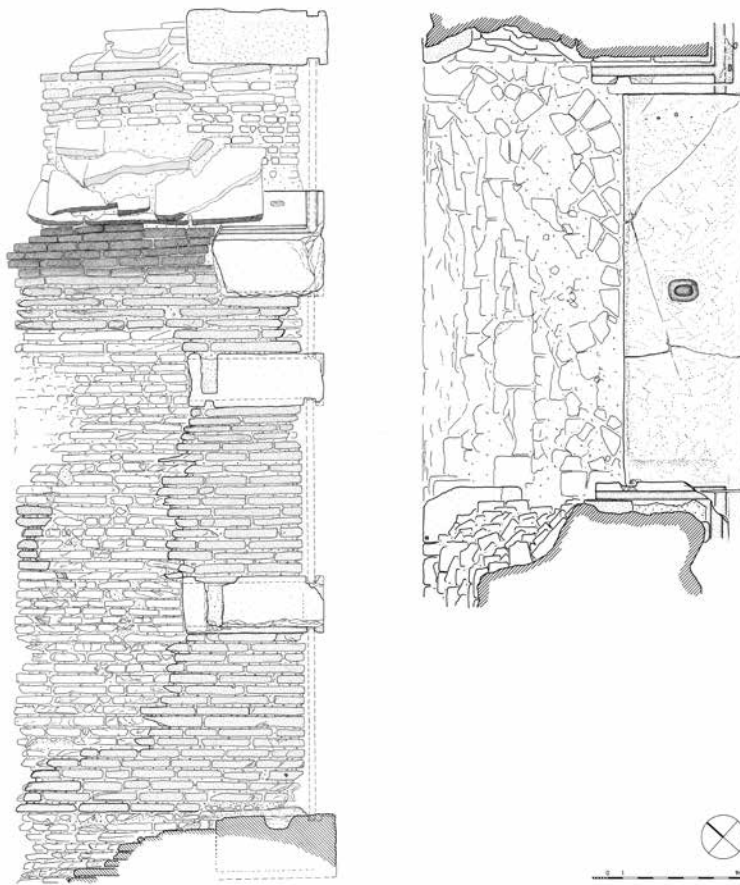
Pergamon, Rote Halle. Südwand, Bauaufnahme des westlichen Fensterjochs im Obergeschoss. Grundriss mit der Sohlbank (rechts) und Querschnitt mit Blick auf die östliche Fensterwange (links) (M. 1 : 500)
